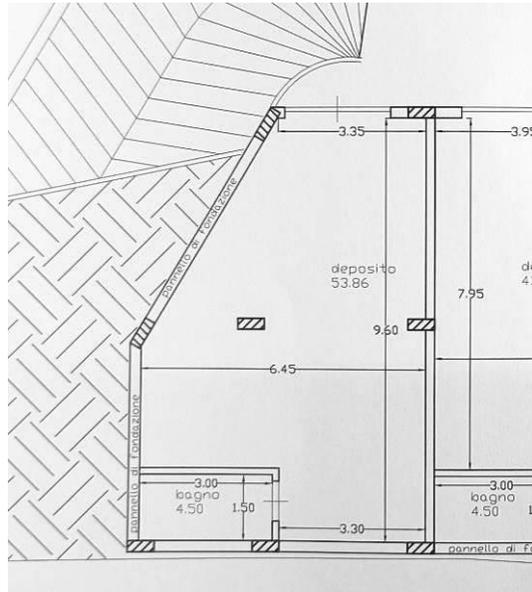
Pianta elaborato D.I.A. prot. 47398/2010
